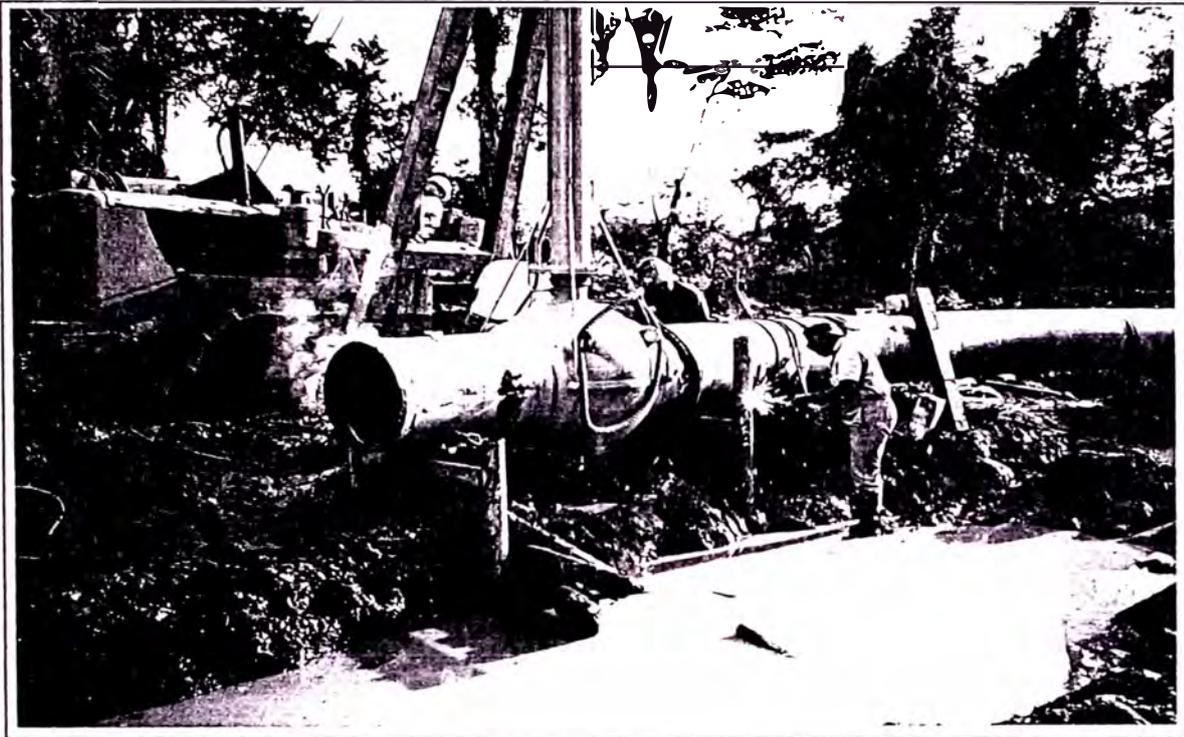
Corte de tubo pilotes excedente y soldadura de Válvula a tubería en margen izquierda.
